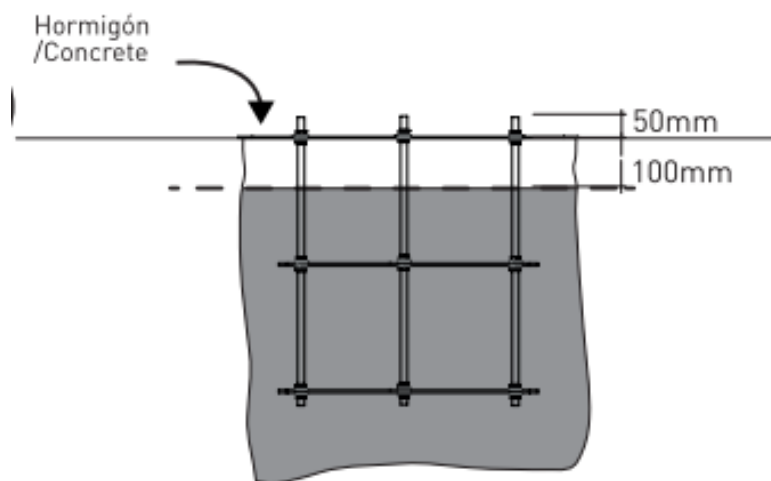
Llenado de la zapata con hormigón <sup>[15]</sup>
